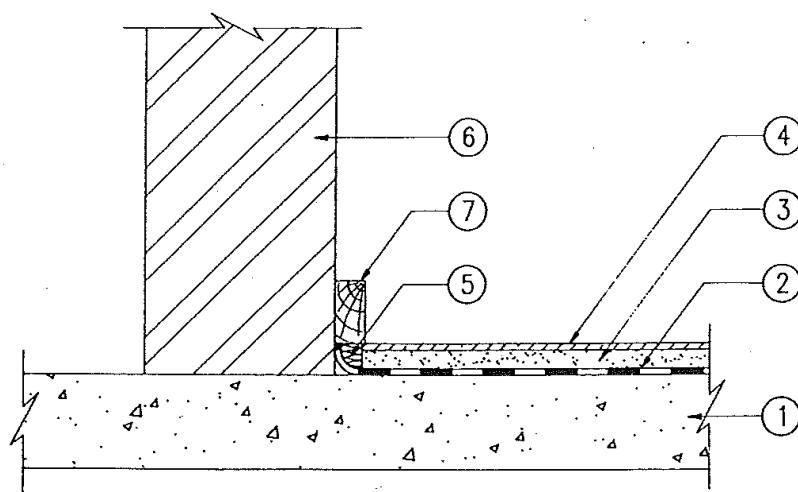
Pormenor de execução da impermeabilização num piso térreo<sup>3</sup> [10]
